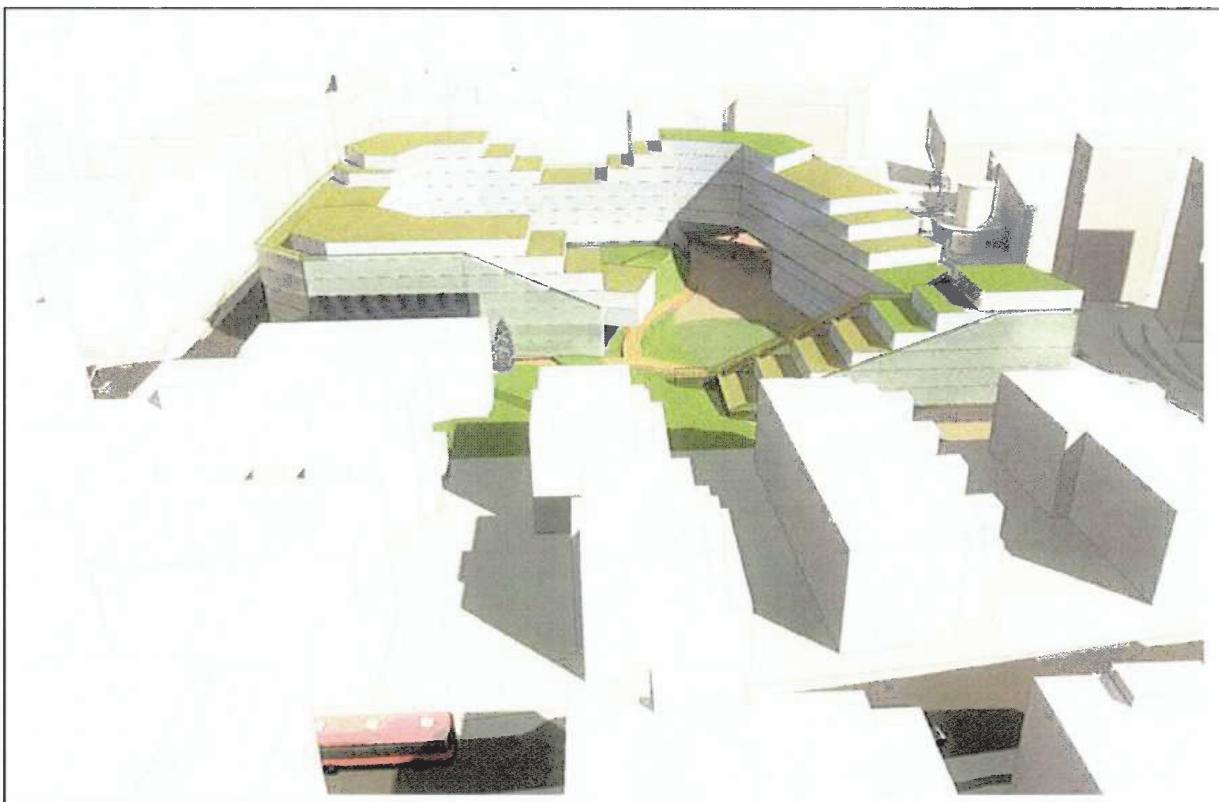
Forslag til utvikling av planområdet sett i forhold til eksist. og planlagte strukturer på Løren.
